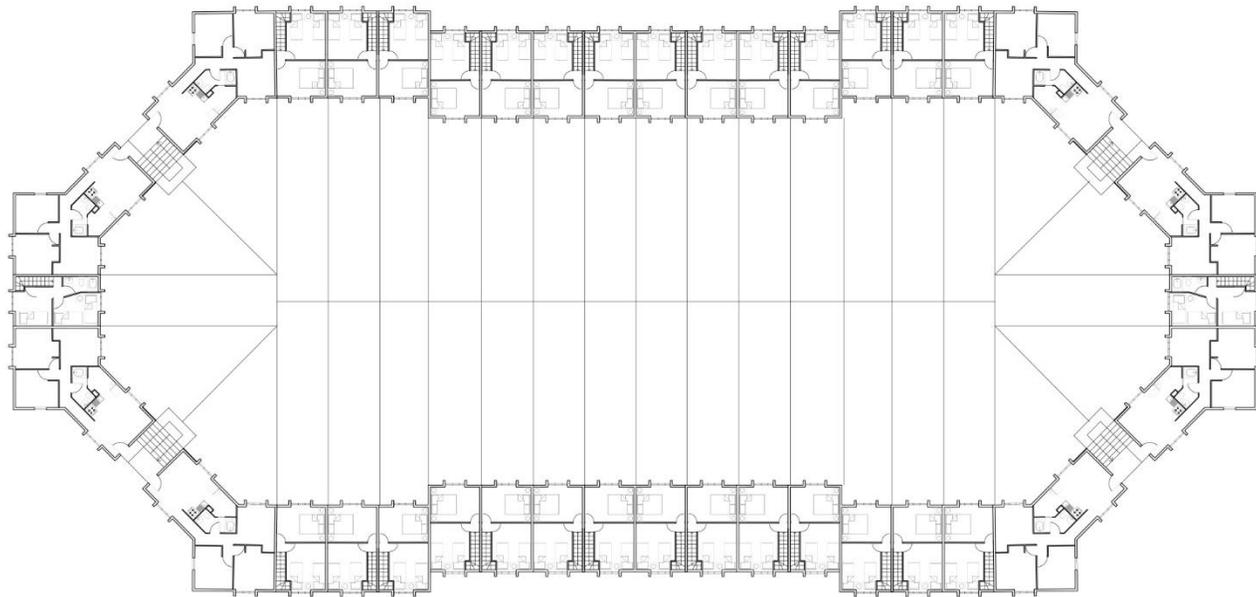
Planta piso tipología 3 Lo Ermita, esc. 1:500. Fuente: Elaboración propia
